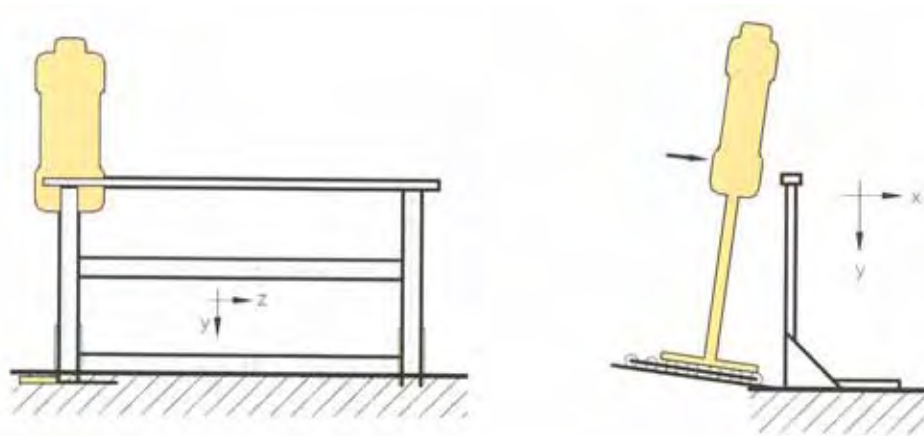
Essais dynamiques sur un montant d'une seule travée ancrée au parapet.
